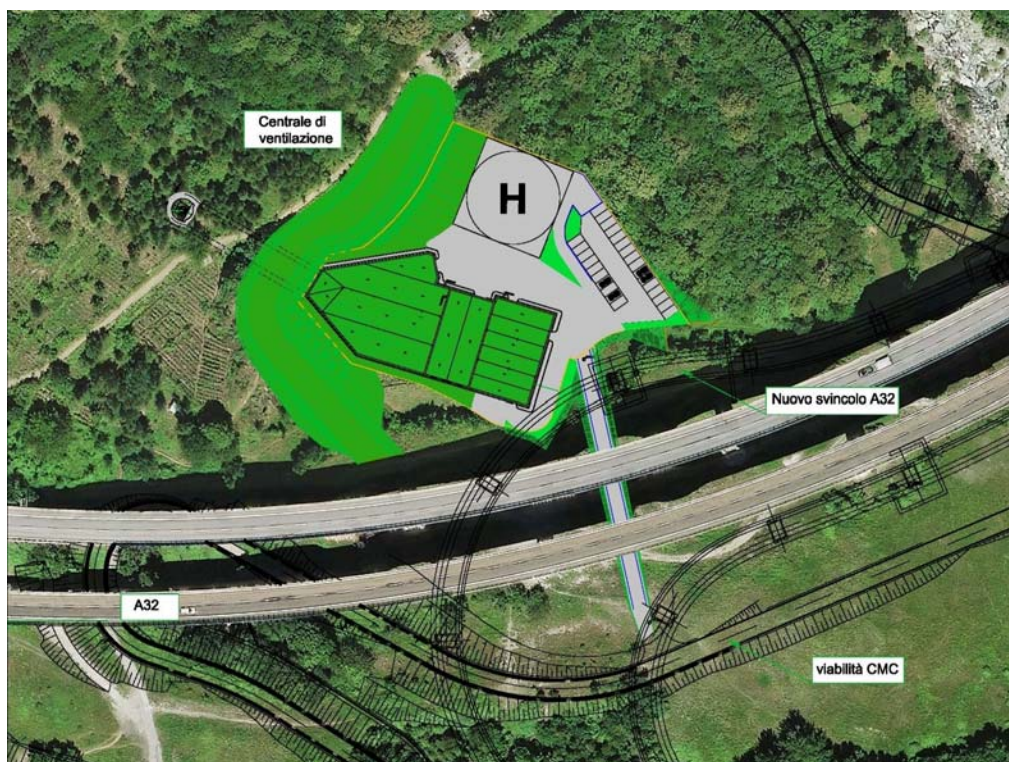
Centrale di ventilazione di Maddalena dal progetto definitivo approvato
